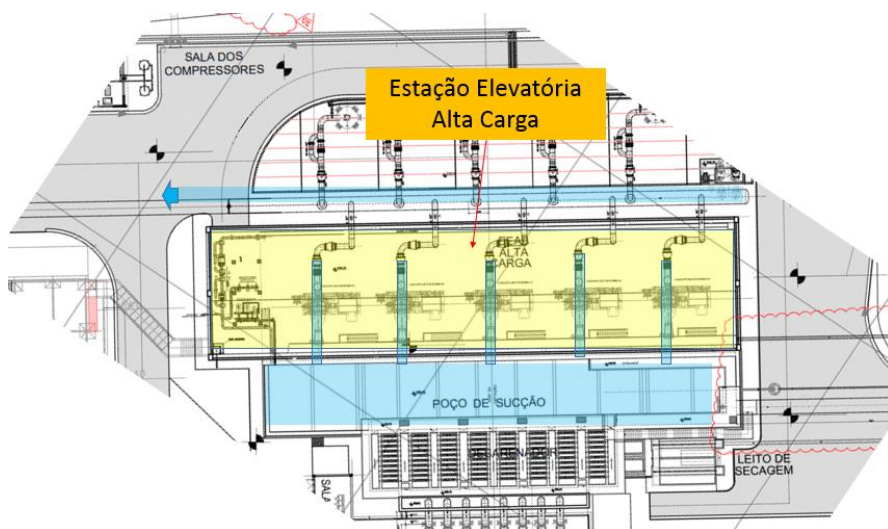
Estação Elevatória de Alta Carga / Casa de bombas, vista em planta
